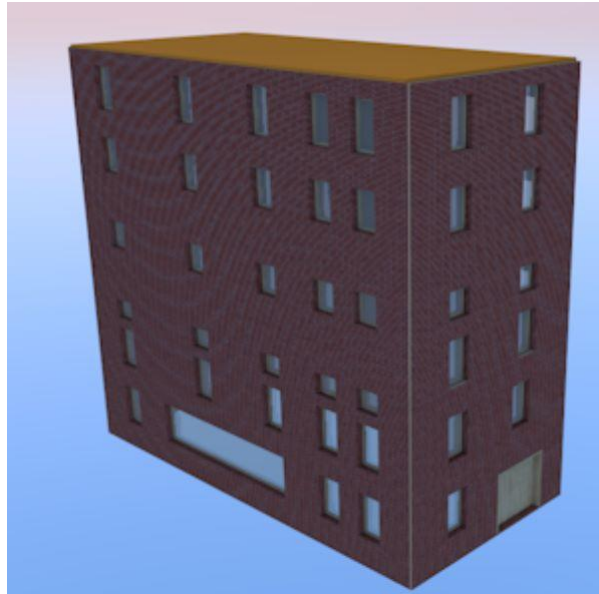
Fachada de la edificación. Fuente: Nicolás Pozo
